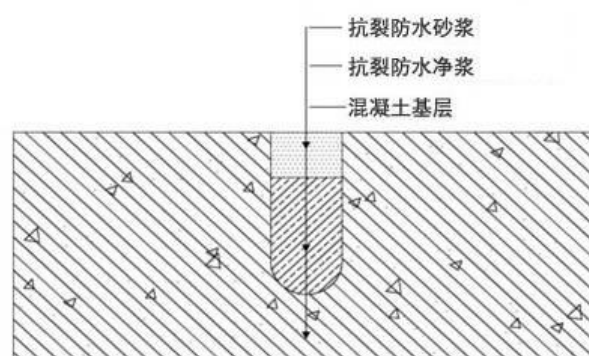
混凝土裂缝修补（开槽法）构造图
